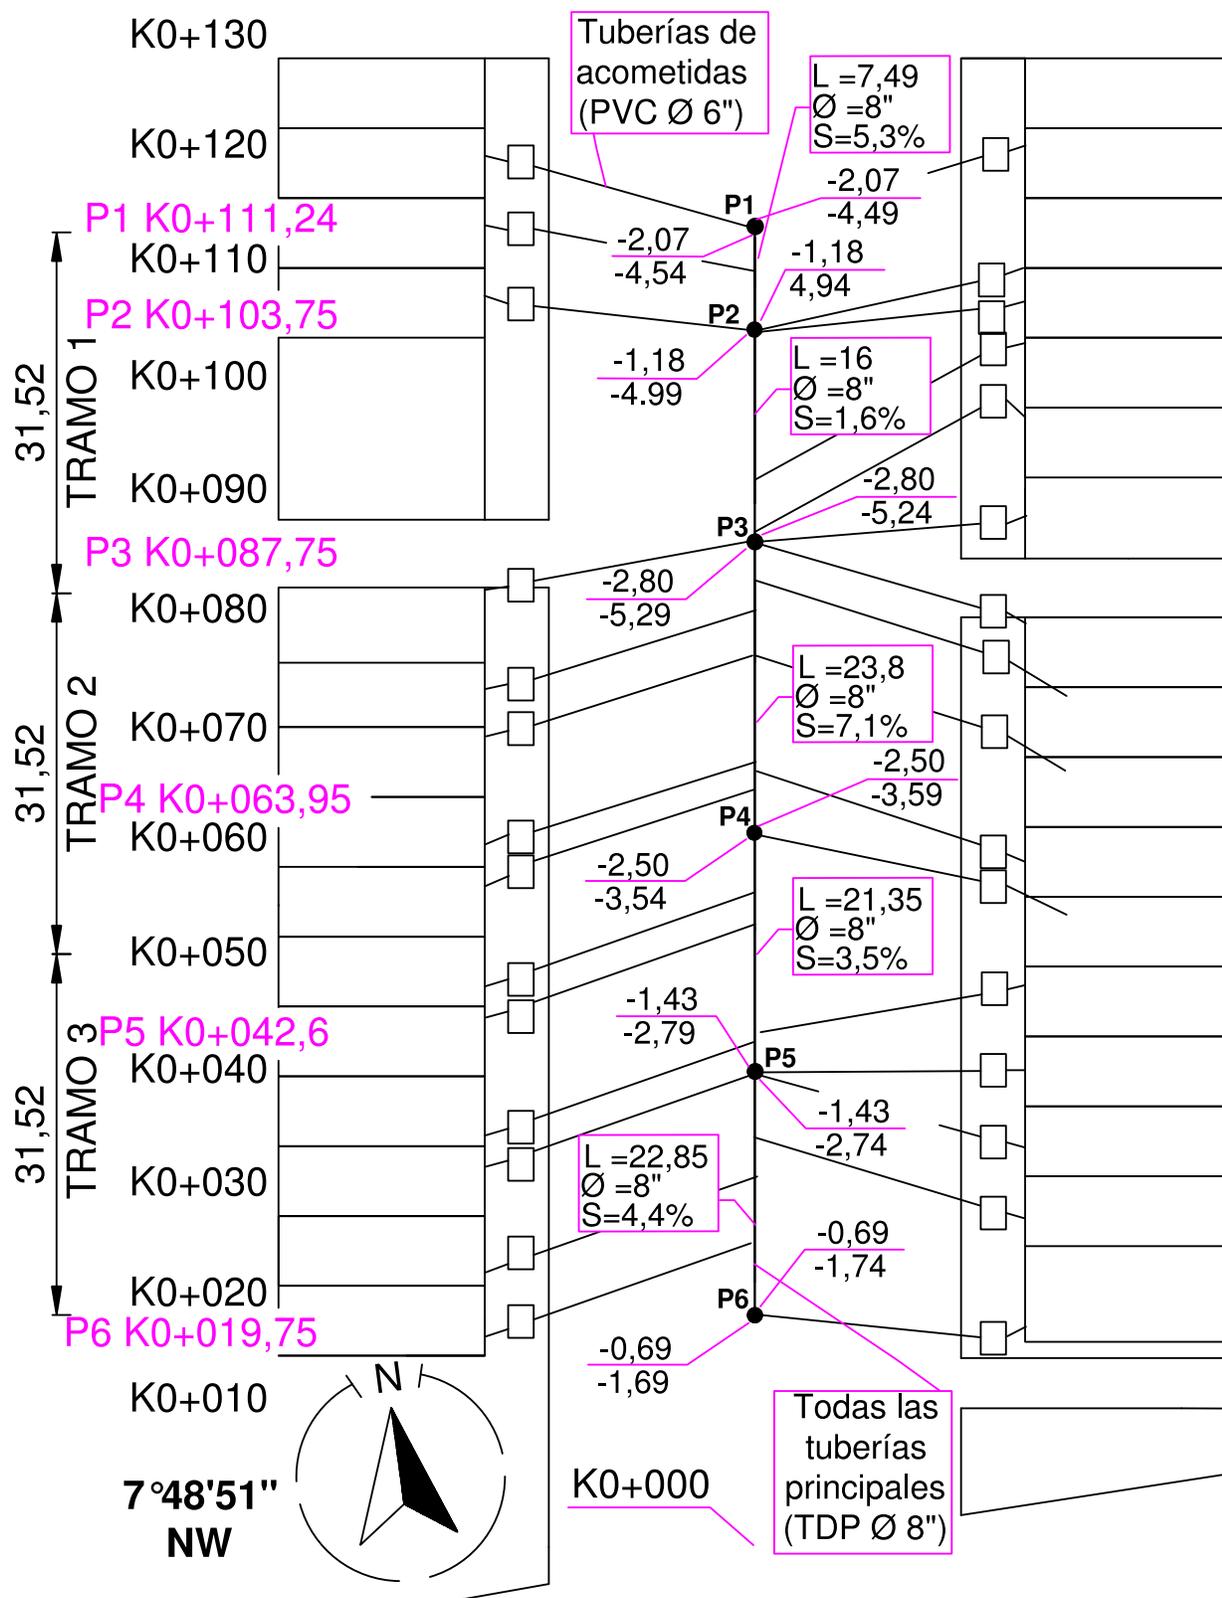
Plano de la red de alcantarillado. Fuente: Elaboración propia.
